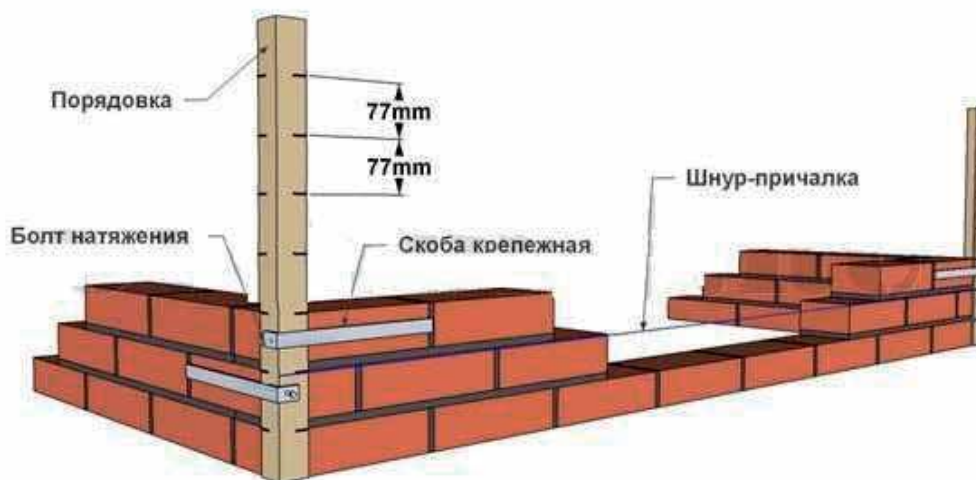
Схема установки порядовки и шнура-причалки
